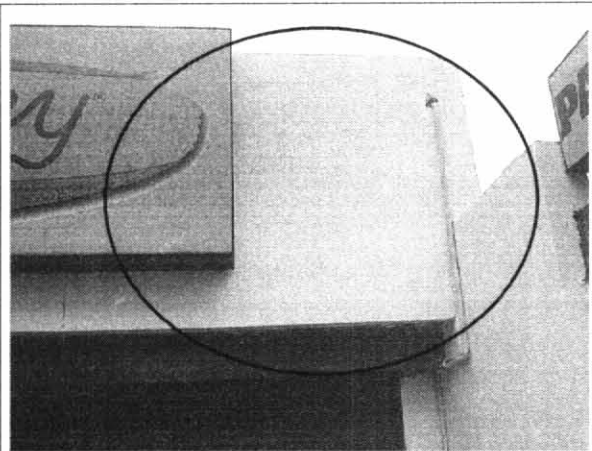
Fisuración del antepecho en fachada. El muro se encuentra suelto y sin ningún tipo de amarre estructural.
